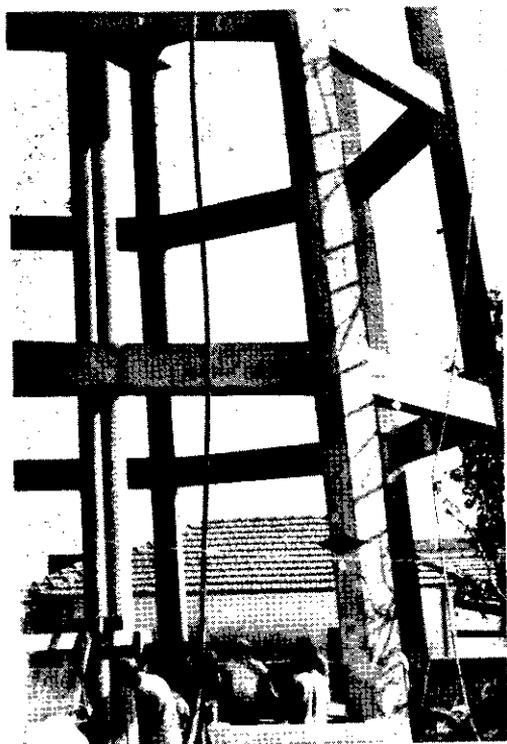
Vista dos Pilares na parte baixa já recuperados.
